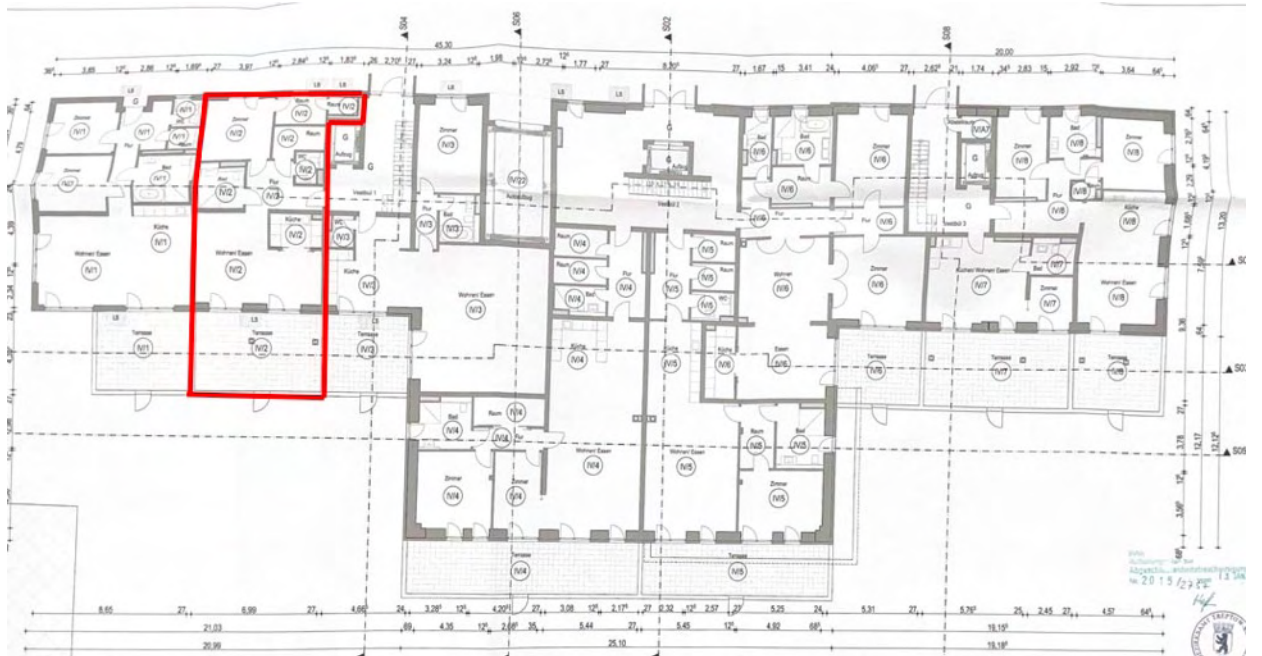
Grundriss Aufteilungsplan, Erdgeschoss mit Wohnung Nr. IV/02
